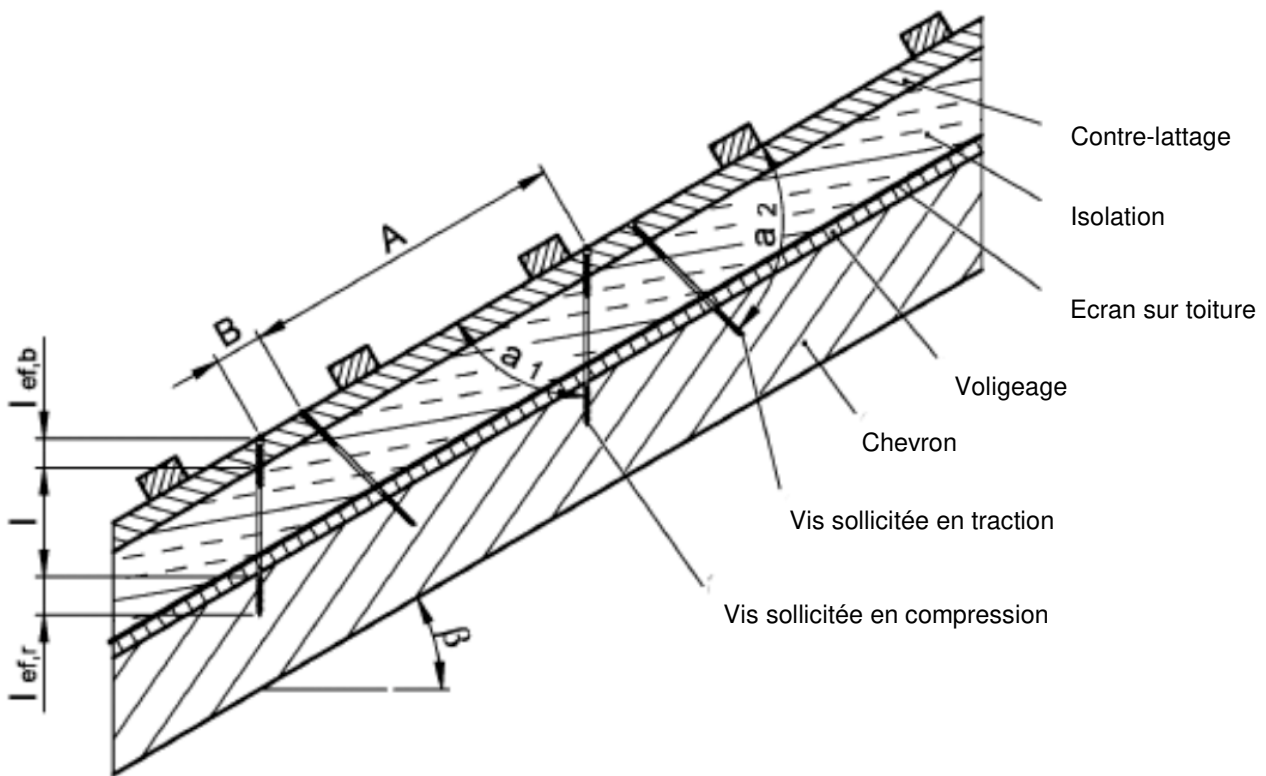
Fixation de l'isolation sur toiture sur chevron - Schéma de principe avec des vis disposées suivant une inclinaison variable
